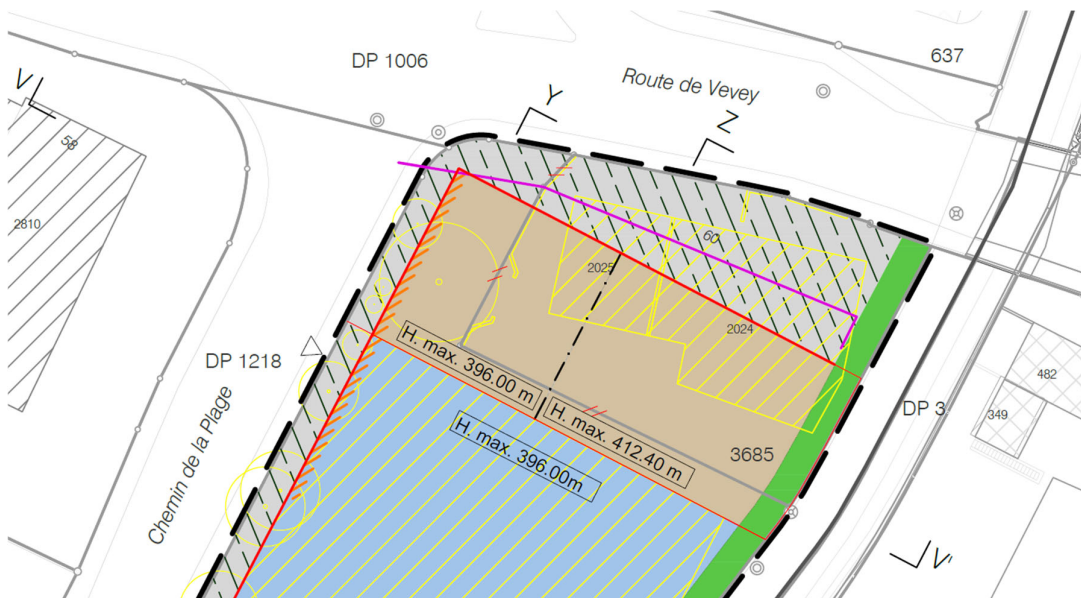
/ Plan de détail : zoom sur le périmètre d'implantation des constructions B
